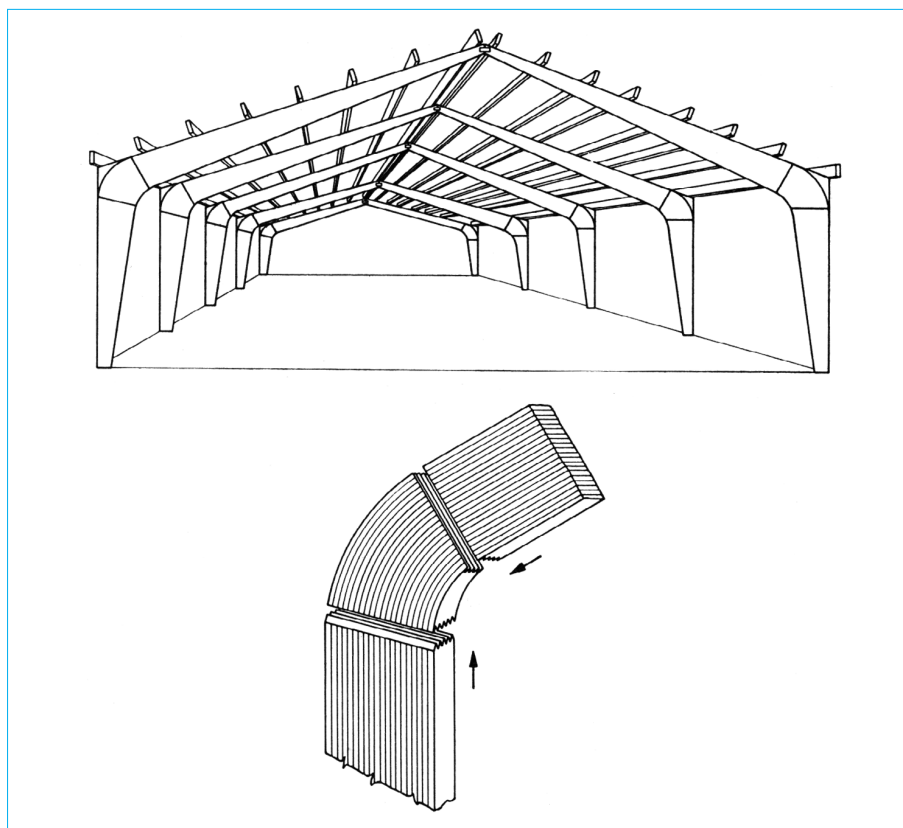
Hall à usages divers : poutres droites (portée de 10 à 25 m) et détail d'assemblage d'angle à entures multiples
